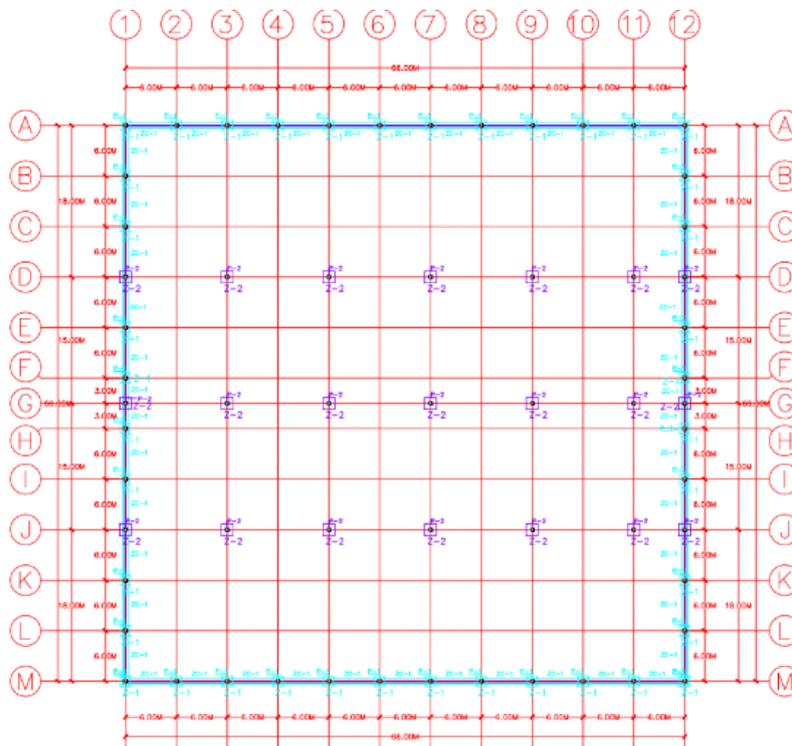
Ubicación de Zapatas Z-2 en Nave 3
